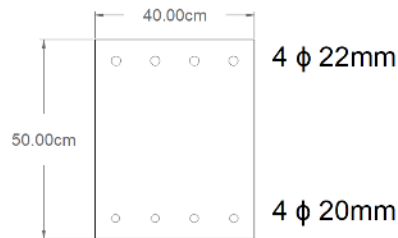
Armado longitudinal viga del piso 1 pórticos 1-5
